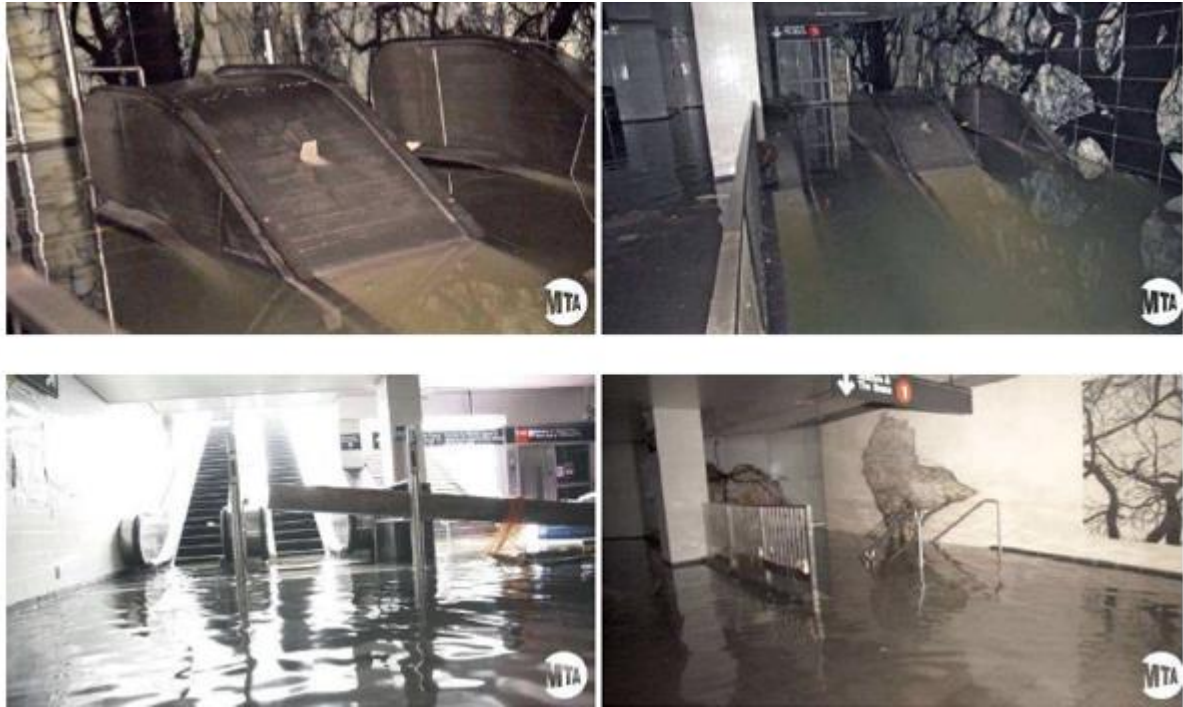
Inondation des stations de South Ferry et Whitehall Street (Source, MTA).
